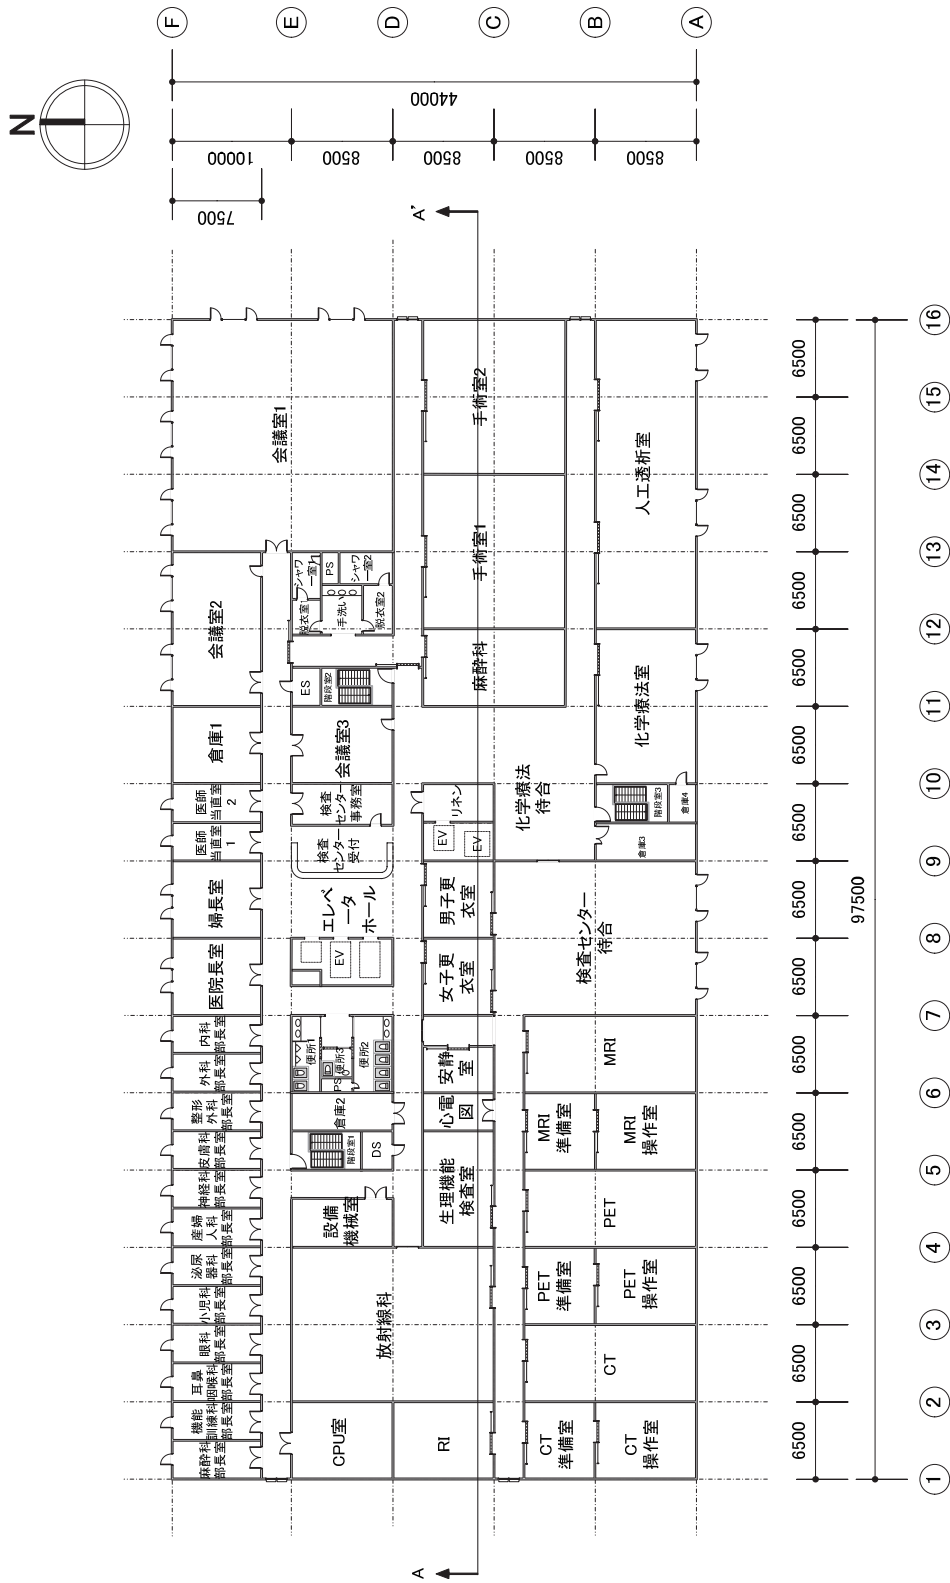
A.10 モデル建物 (病院等、20,000㎡) 2階平面図
